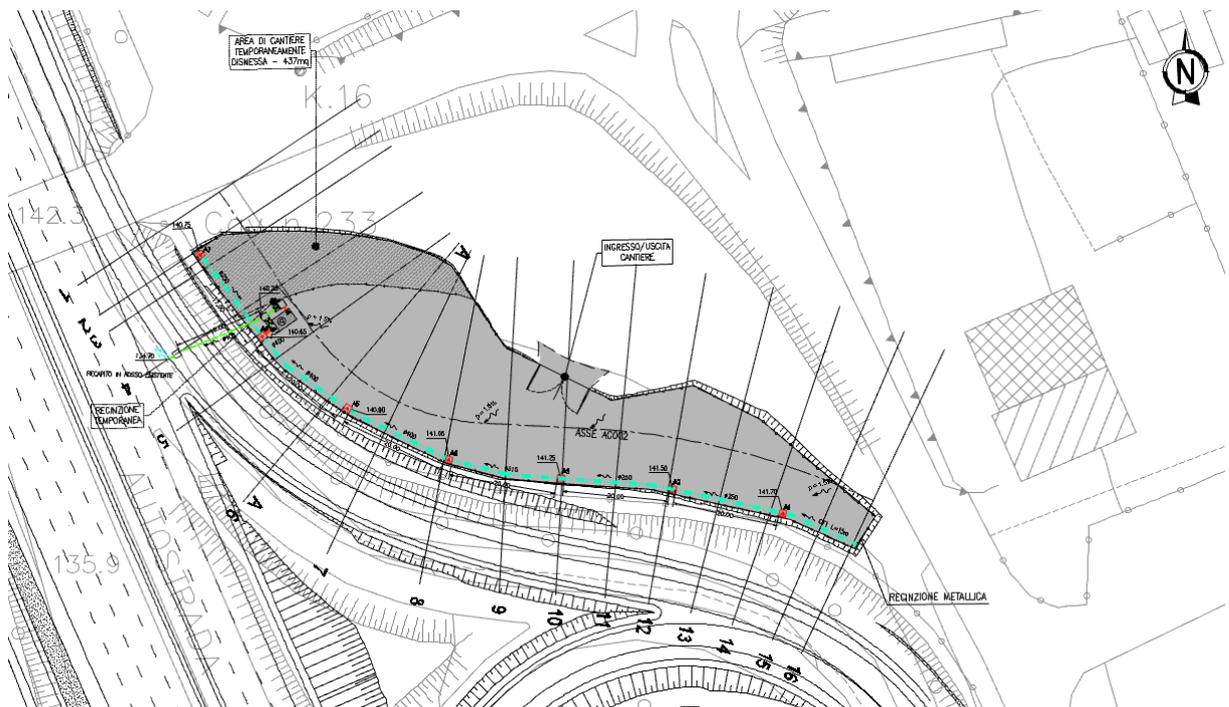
Planimetria reti idrauliche di AC02 – Area supporto progr. km 319+800
